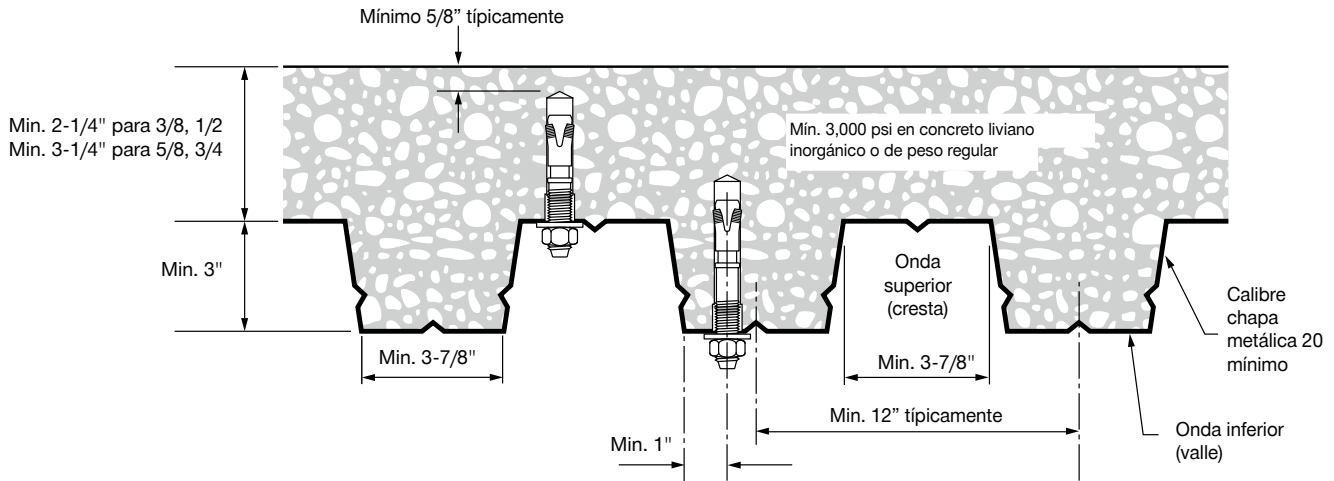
Instalación de Kwik Bolt VTZ en losas compuestas sobre chapa metálica
